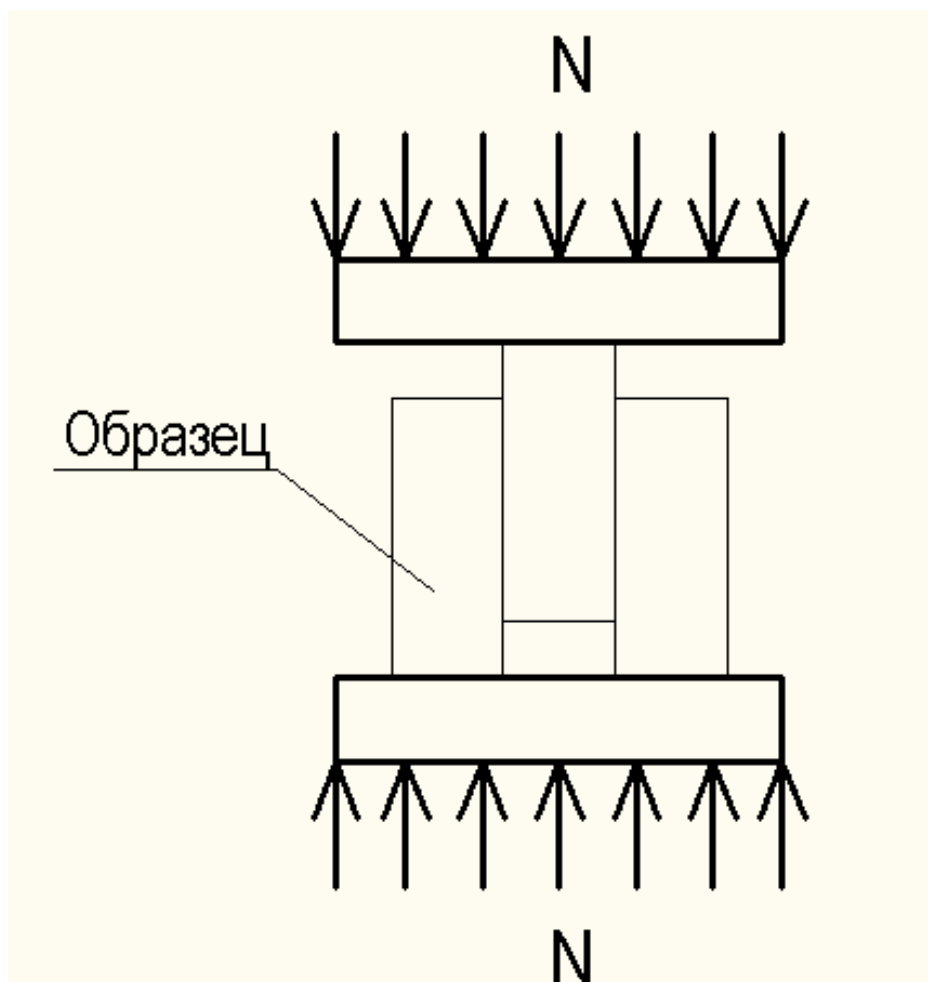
Схема испытания опытных образцов на срез (касательное сцепление)
